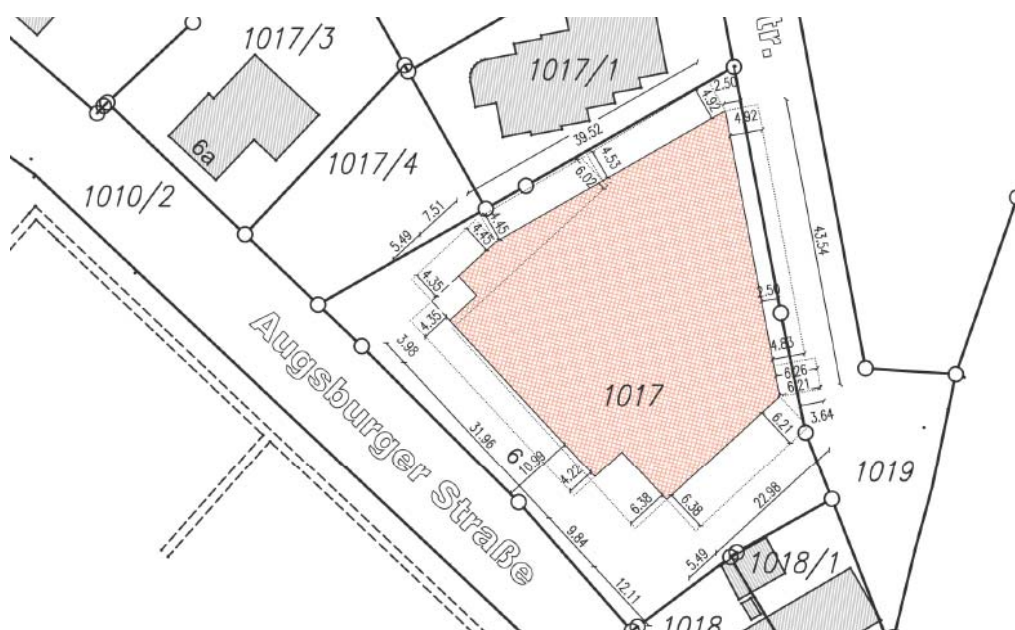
Lageplan mit Abstandsflächen, Geosys-Eber Ingenieure, Stand: 11.06.2013
